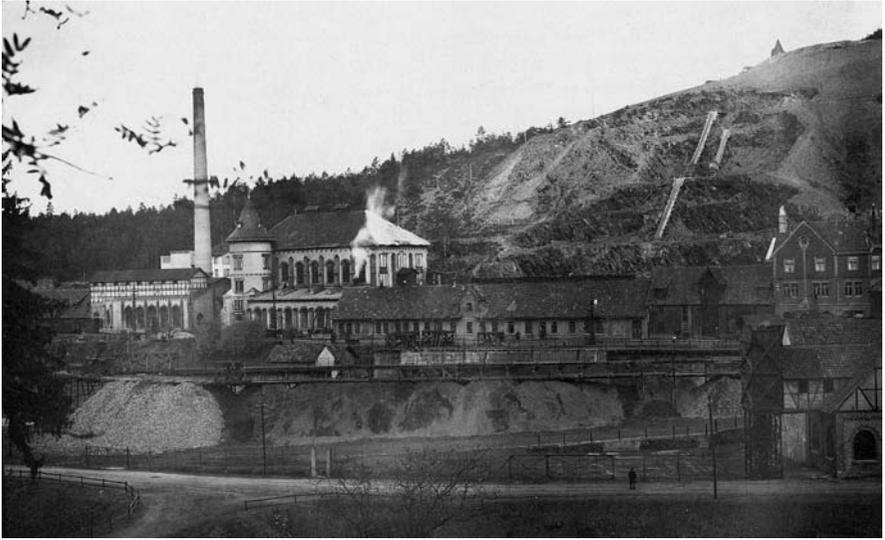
a: Flotationsanlage Rammelsberg im Bau, Strossen geschossen, Foto aus der Sammlung Heinrich Stöcker
